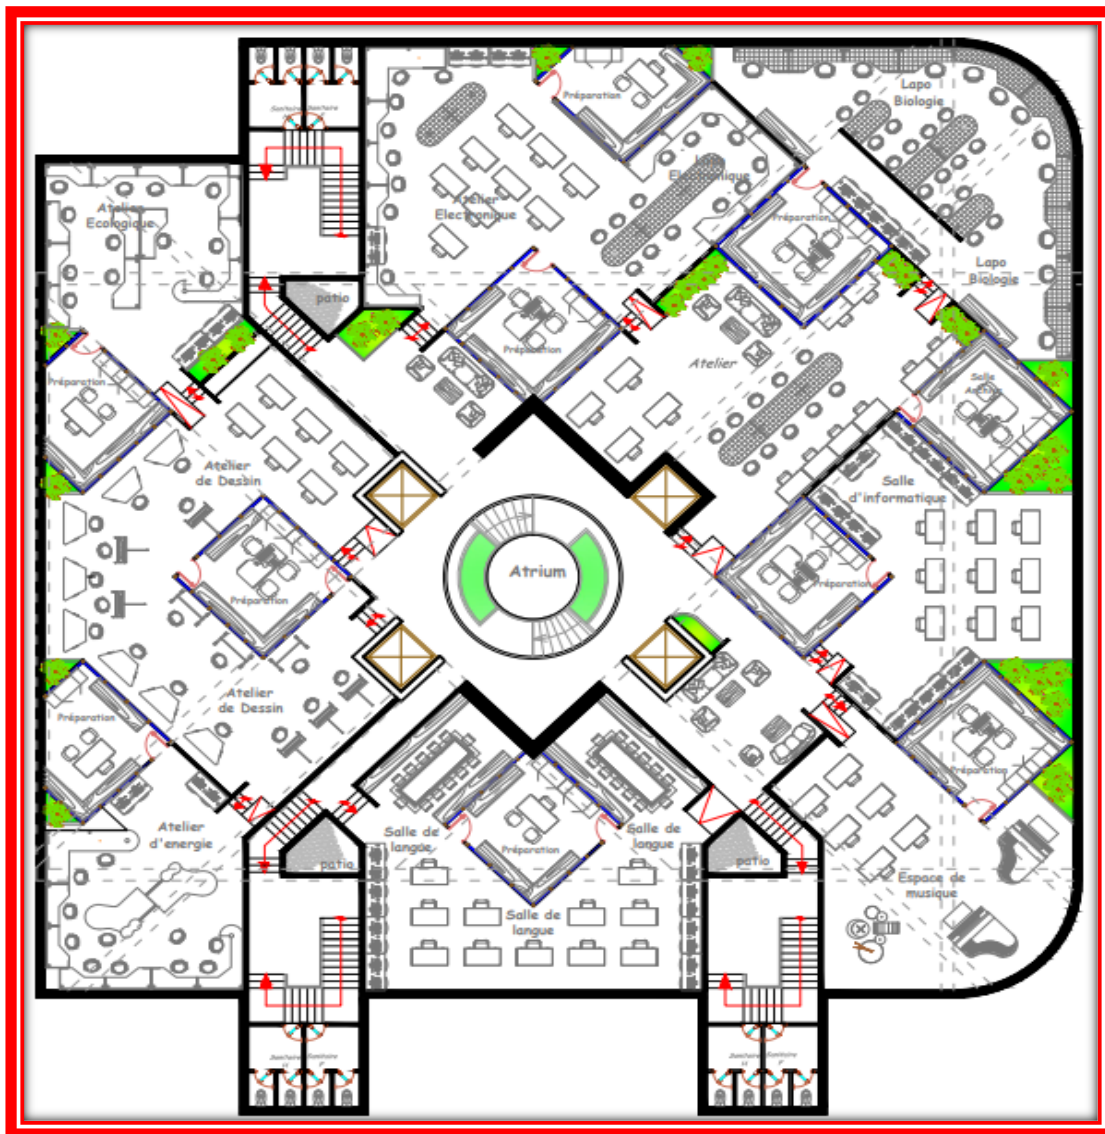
Le plan de niveau 2 (le casse-tête) / source :auteur
